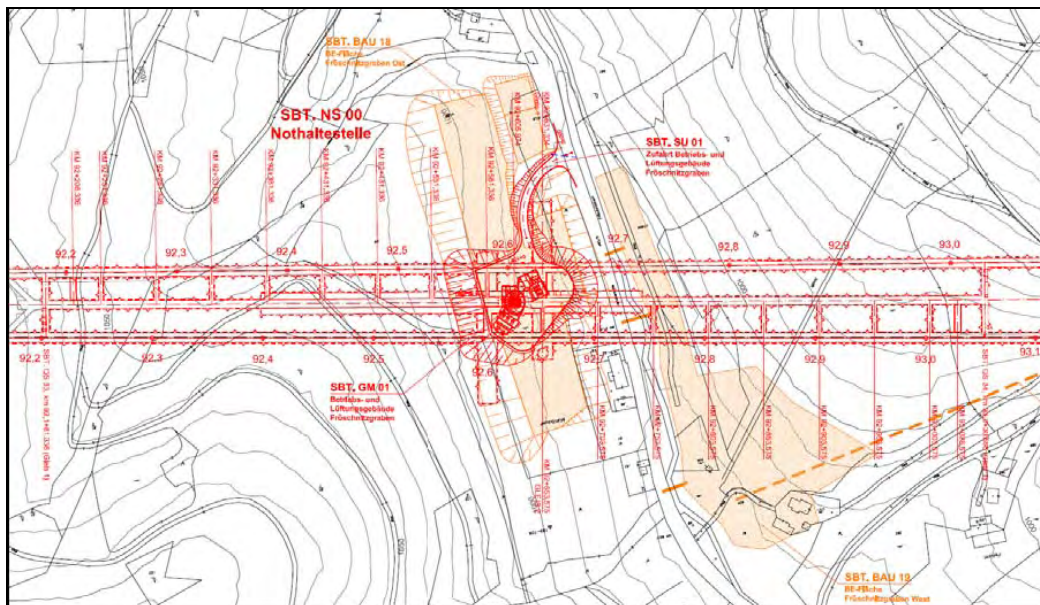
Ausschnitt Lageplan Nothaltestelle
